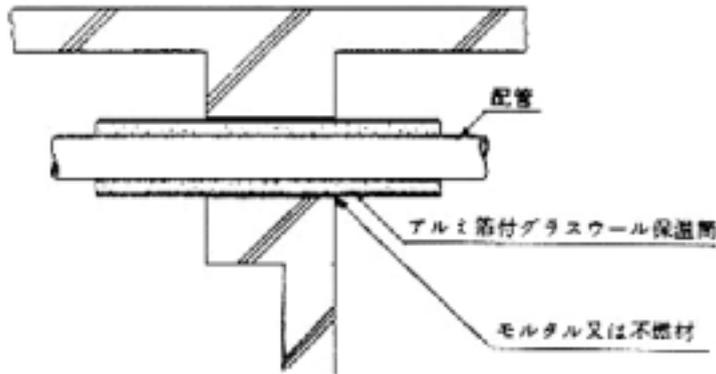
鉄筋コンクリート梁貫通部
